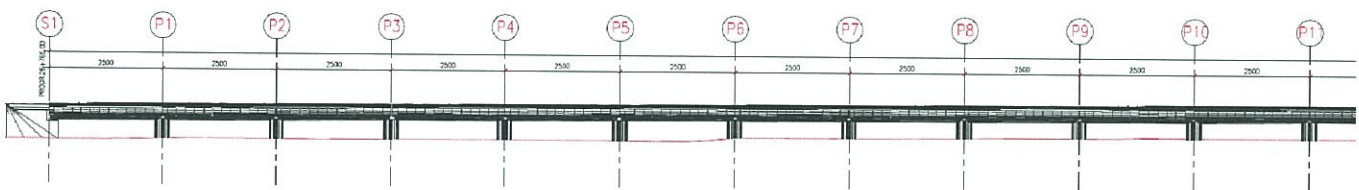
Viadotto Ripalta: stralcio del prospetto
